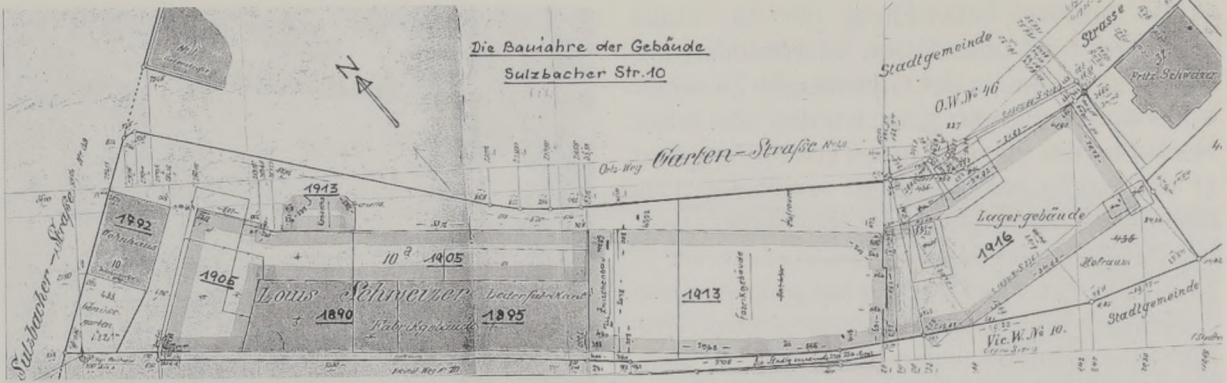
Lageplan Sulzbacher Straße 10 mit den in Abschnitten entstandenen Fabrikbauten von 1890 bis 1916.
